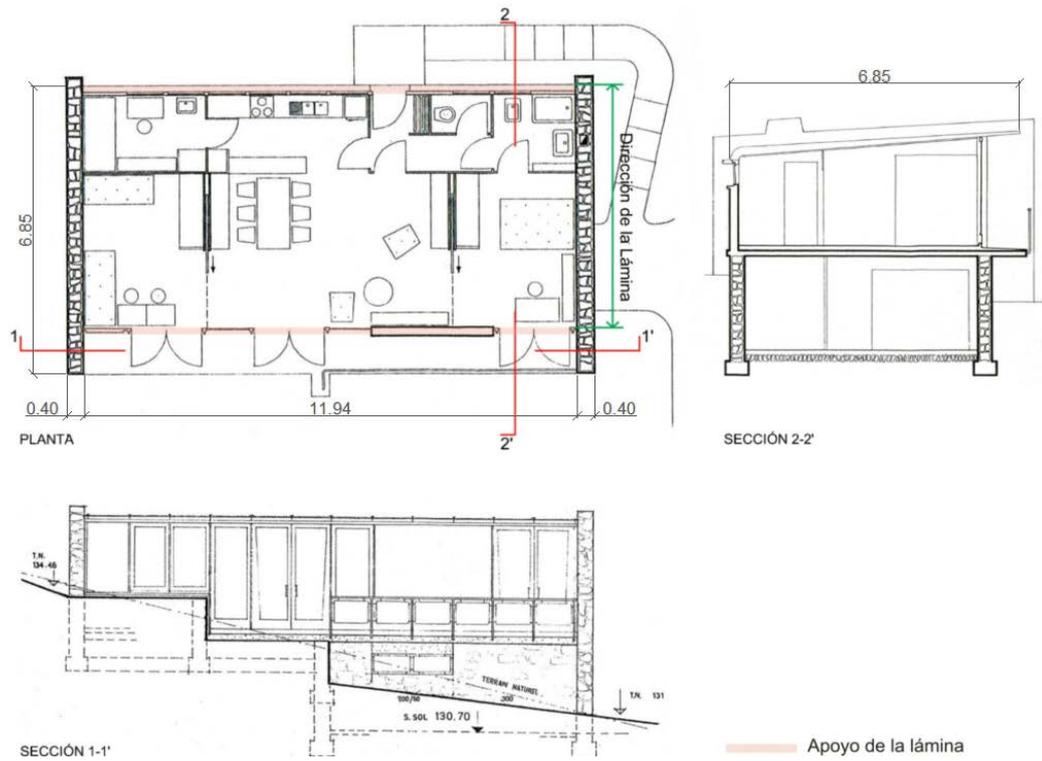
Análisis de la planimetría de la Maison Coque n°6.
